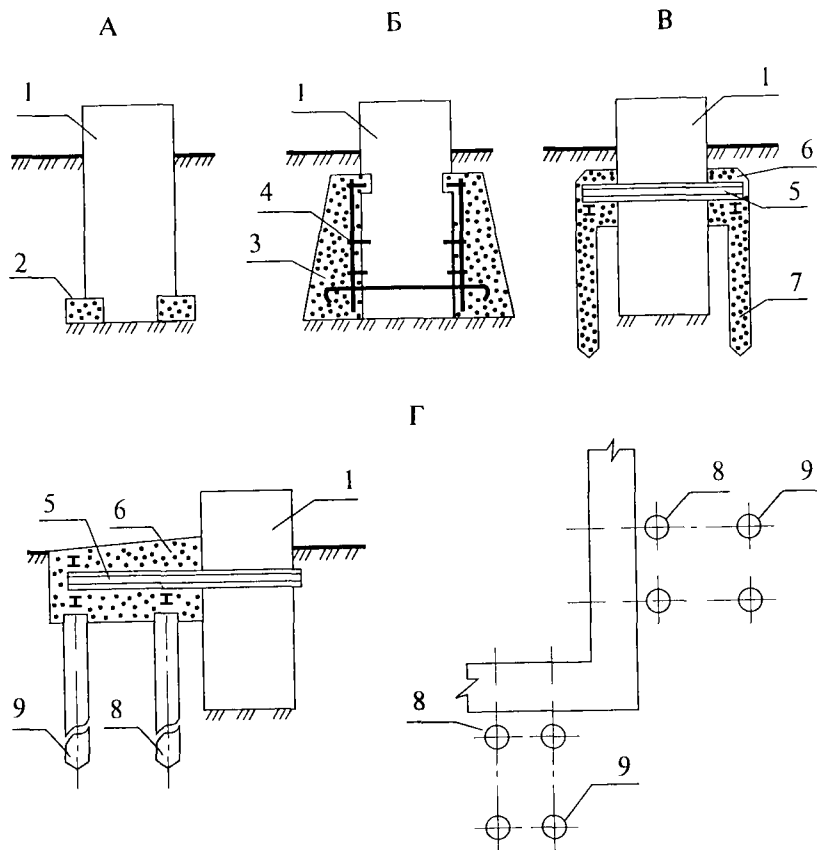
Способы усиления и разгрузки ленточных фундаментов:
